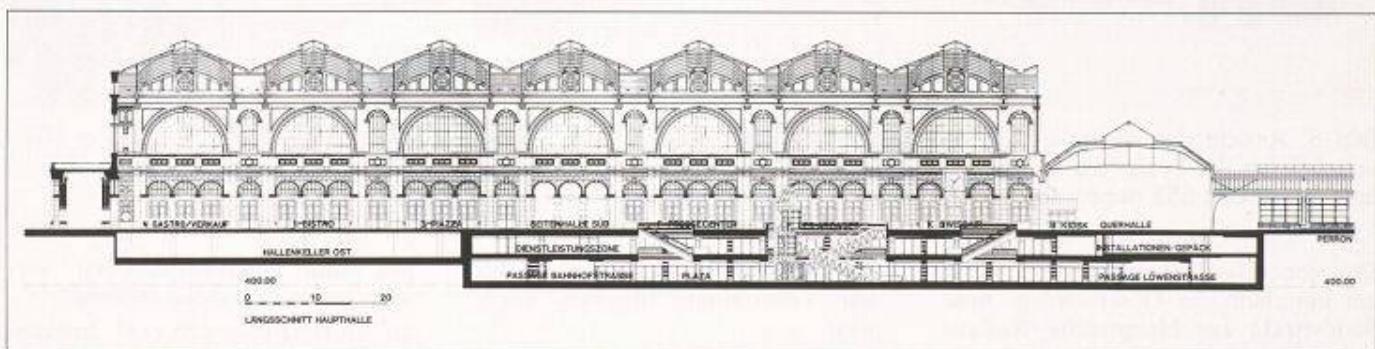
Projektplan 1992 (Längsschnitt durch die Haupthalle)
